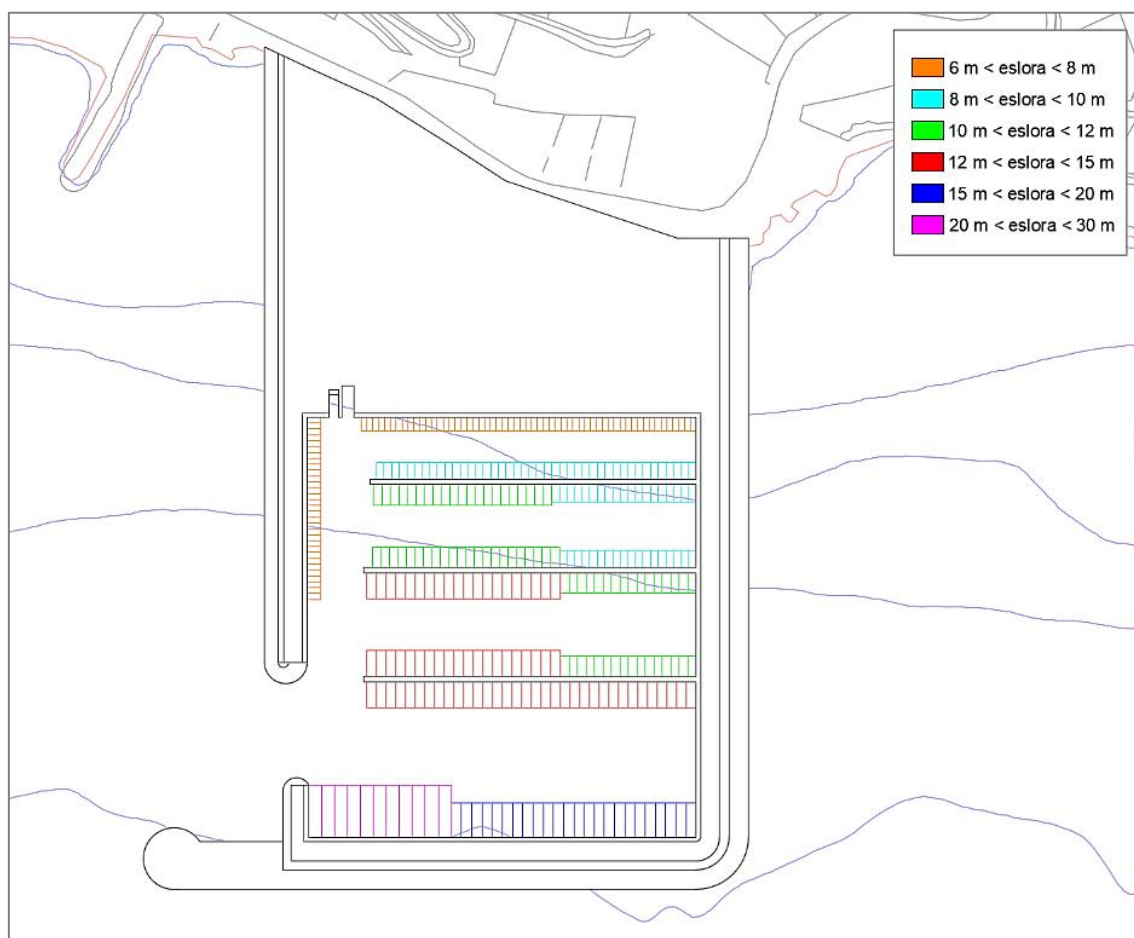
Planta del puerto de Benicasim y distribución de embarcaciones en su interior
